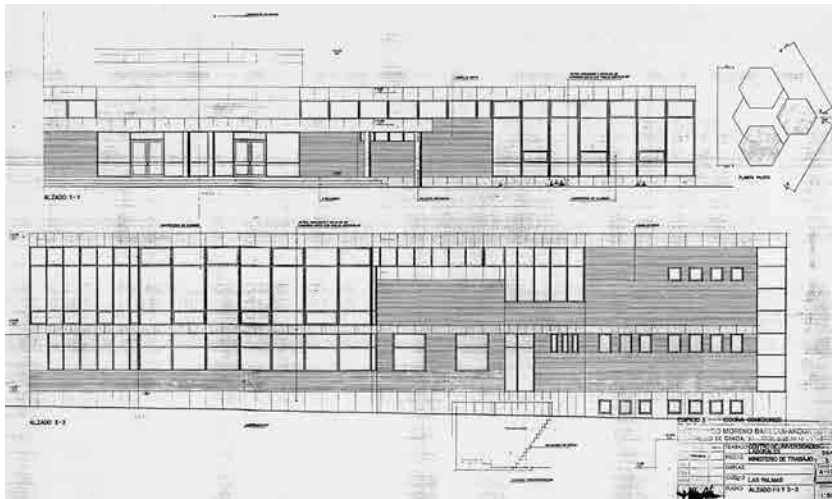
y Fig. 29 Edificio de comedores-cocinas y servicios técnicos. Alzado parcial de la fachada frontal o de acceso (arriba) y alzado de la fachada lateral (abajo).
